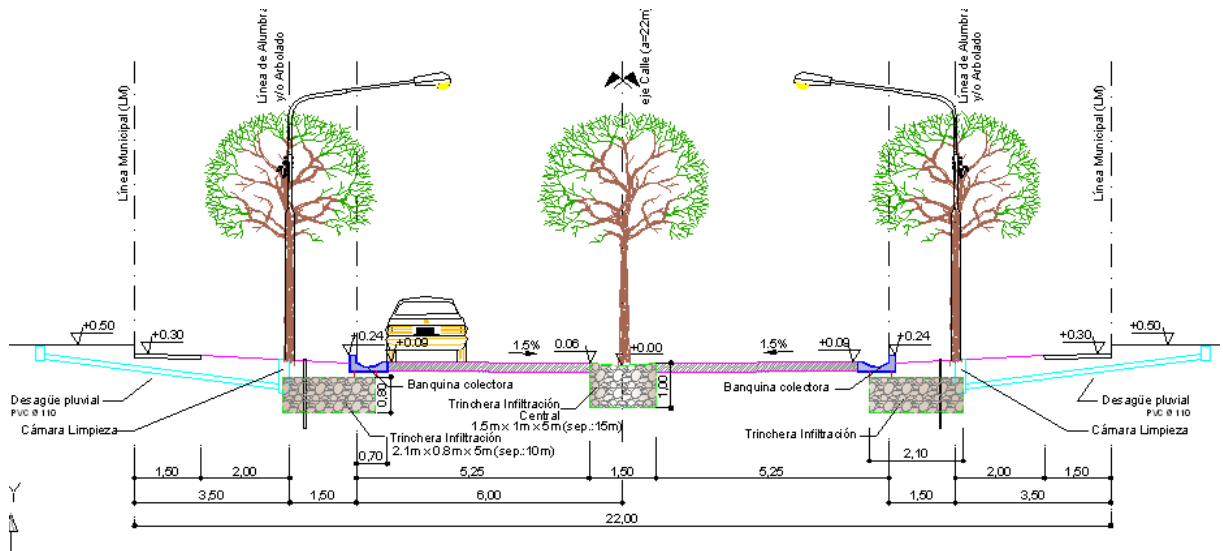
Perfil Tipo para boulevard (Trincheras de infiltración central y bajo banquina colector)
